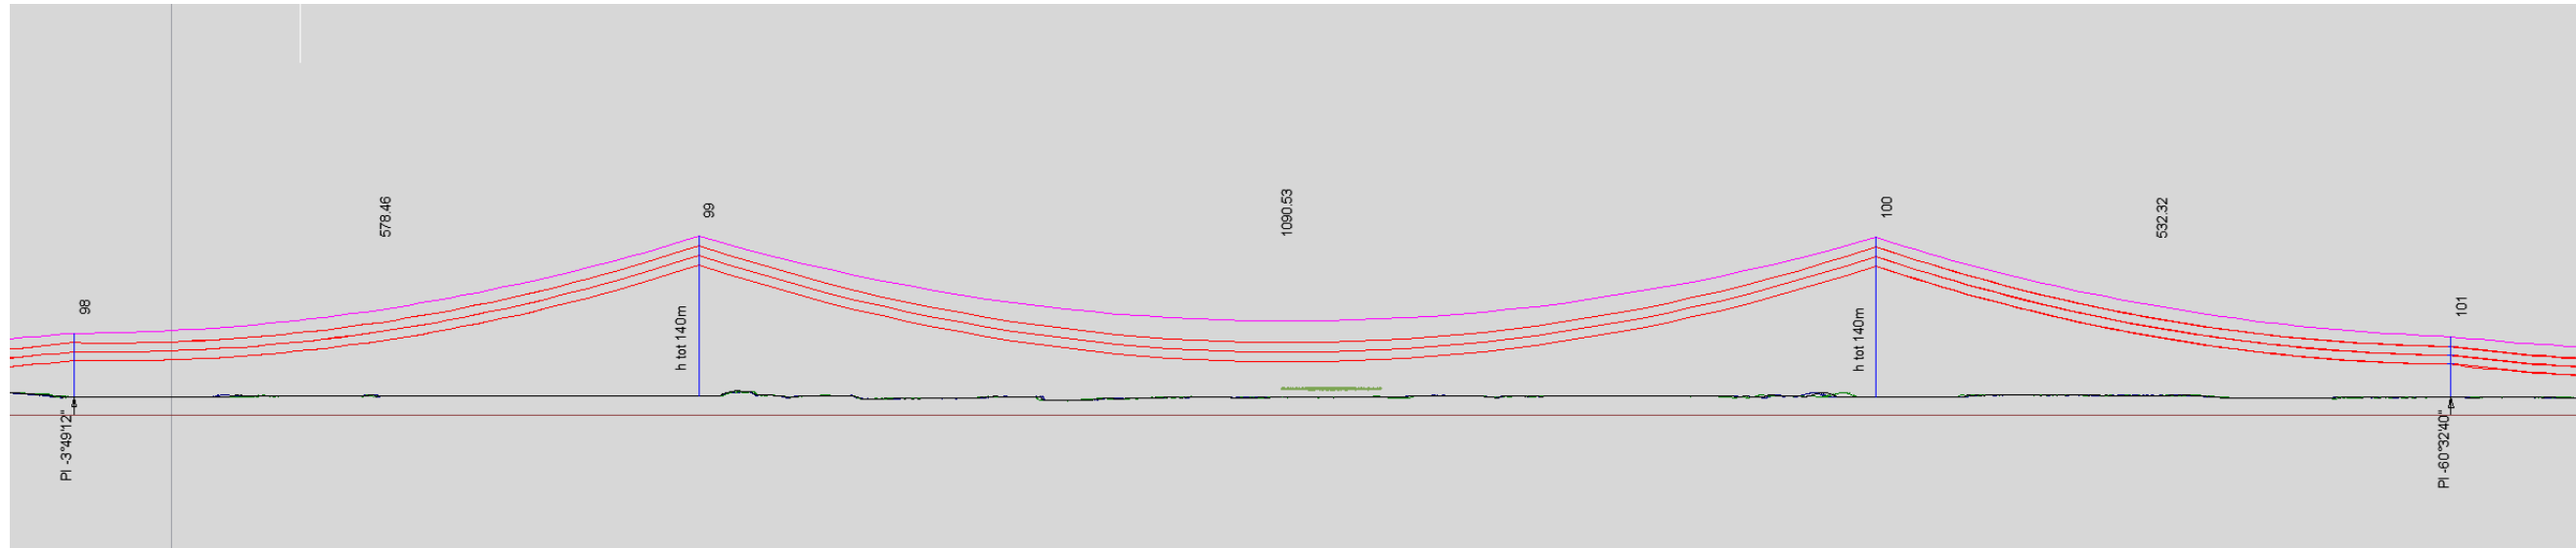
Sezione/profilo schematico della "Soluzione di attraversamento del torrente Torre con piloni esterni alla golaena" (H tot sostegni attraversamento 140m)
